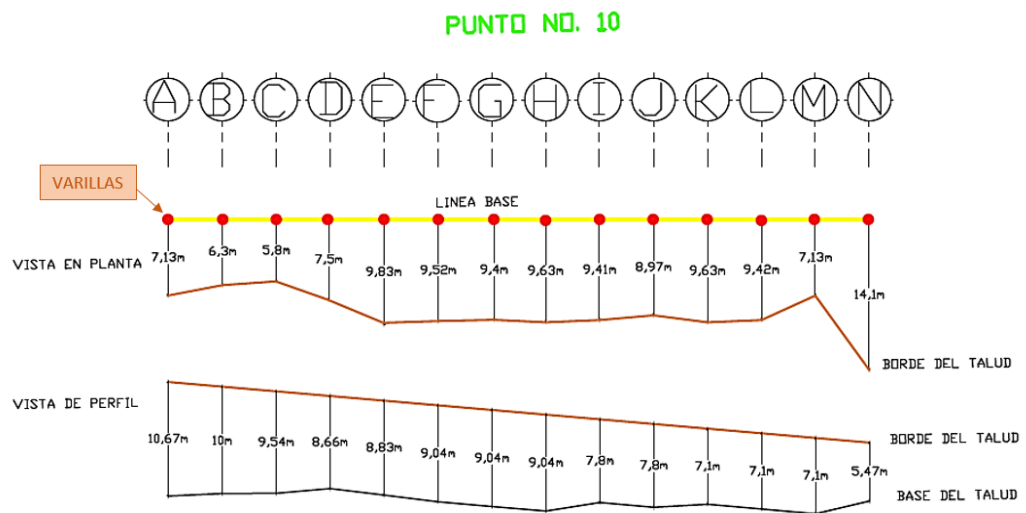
Dimensiones en planta y en altura finales del PUNTO No.10 TALUD ZONA FRANCA III
